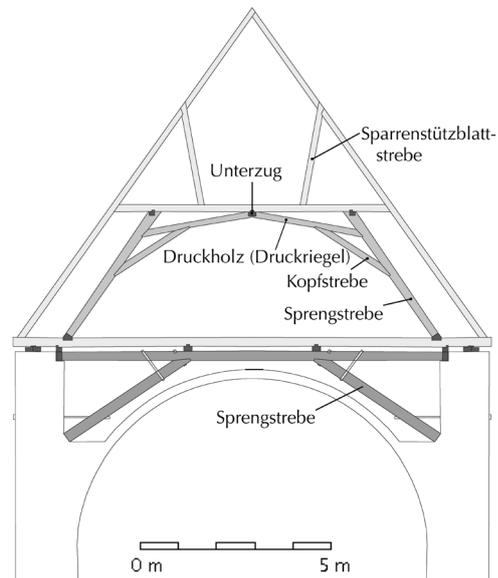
Sprengbünde im Dach und unterhalb der Dachbalkenlage. Umzeichnung nach einem anonymen Entwurf aus dem frühen 17. Jh.
